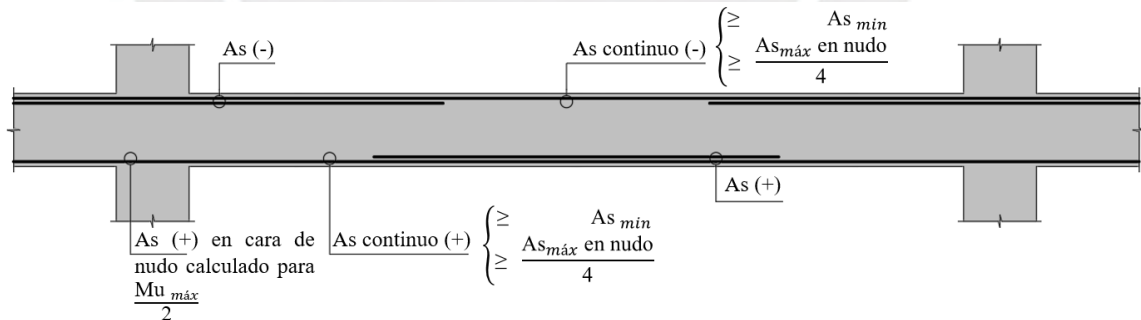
Distribución del acero longitudinal en vigas de pórticos según la Norma E.060 [22]
